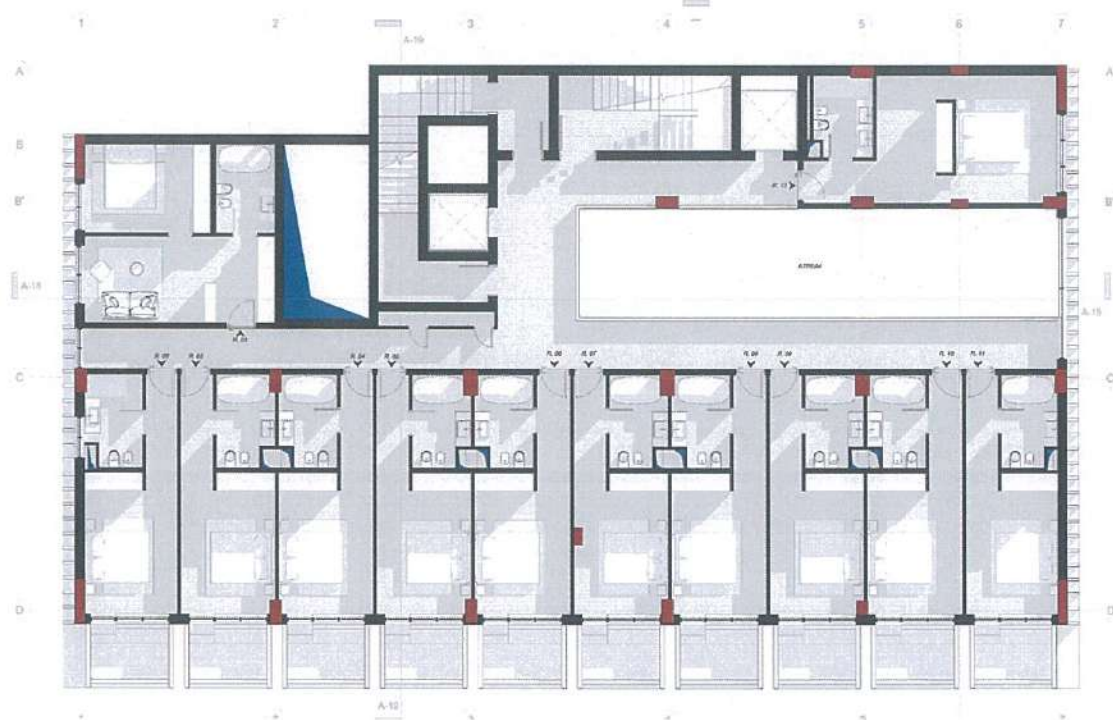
Planimetria e mobiluar e katit +1 South Hotel
